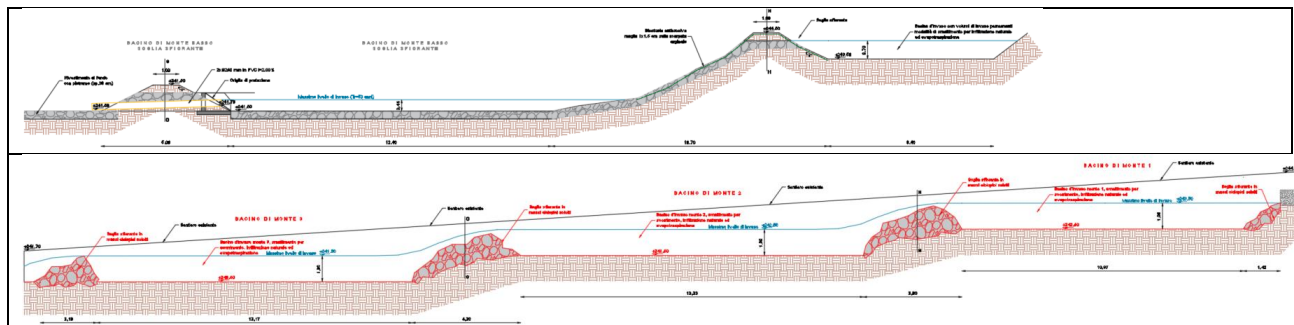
profilo dei bacini nell'area di monte: a) progetto approvato; b) variante proposta
